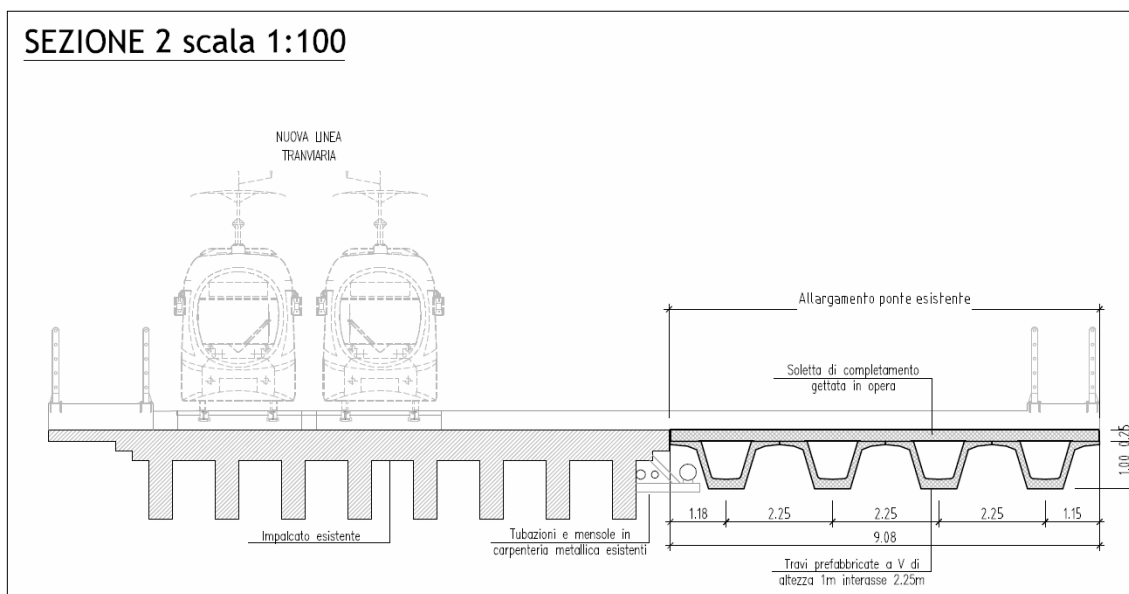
Sezione trasversale ponte in corrispondenza della campata centrale
